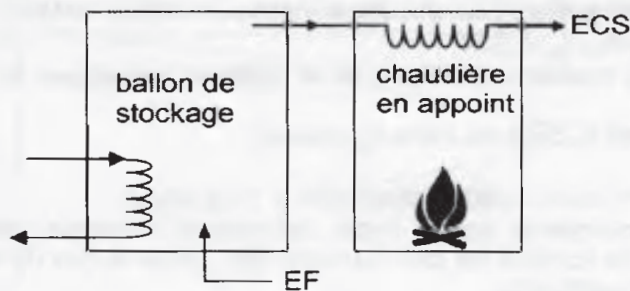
Schéma d'installation d'une chaudière en appoint d'un système solaire.
